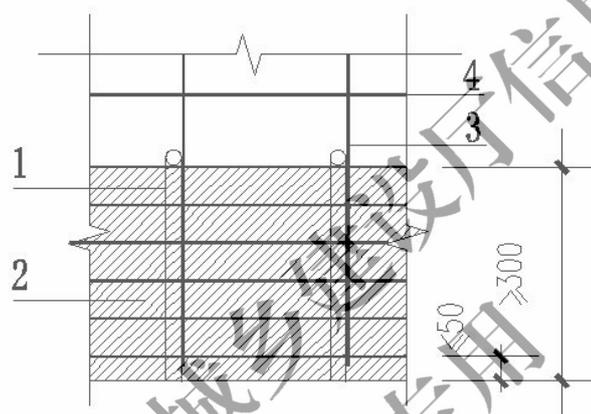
钢筋浆锚搭接连接部位水平分布钢筋加密构造示意图
